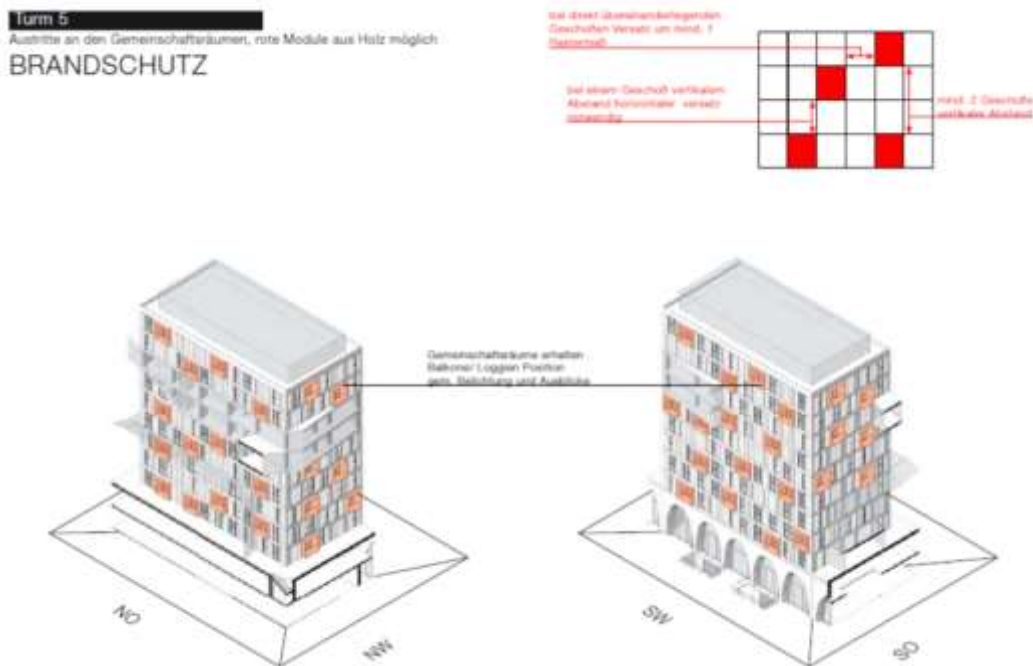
Brandschutz Fassade Turm 5 gem. BauO Bln
